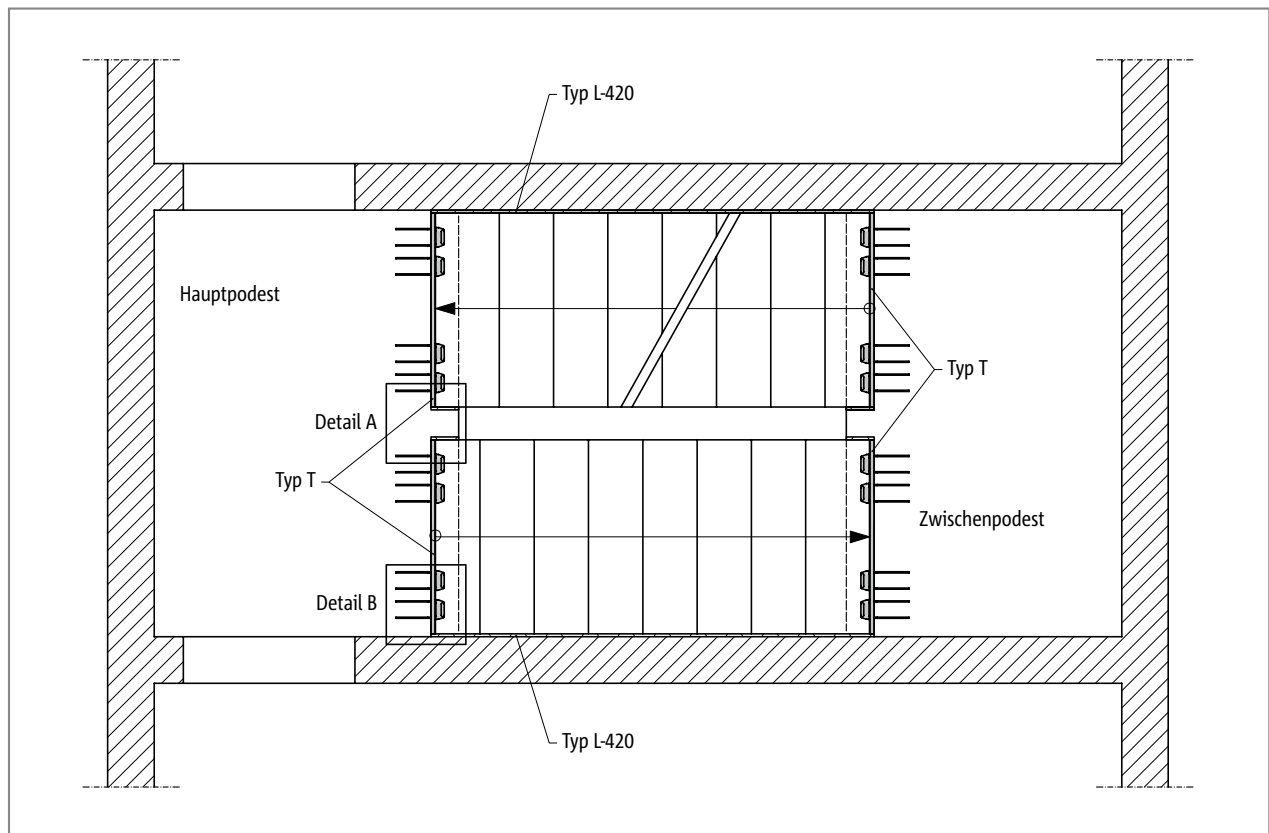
Schöck Tronsole® Typ T: Elementanordnung im Grundriss
